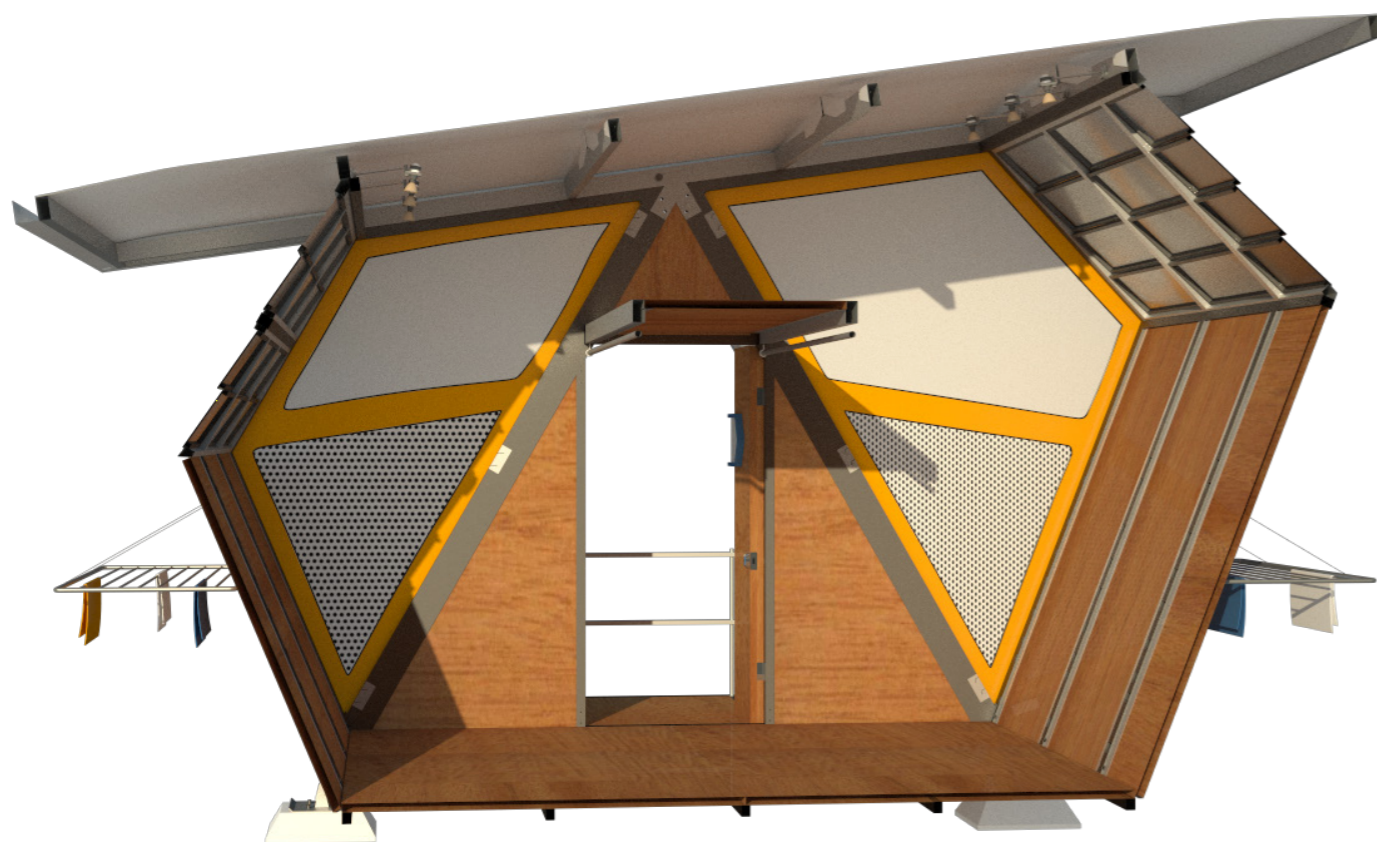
Visualización corte espacial (transversal) del MAD. Autoría propia.
